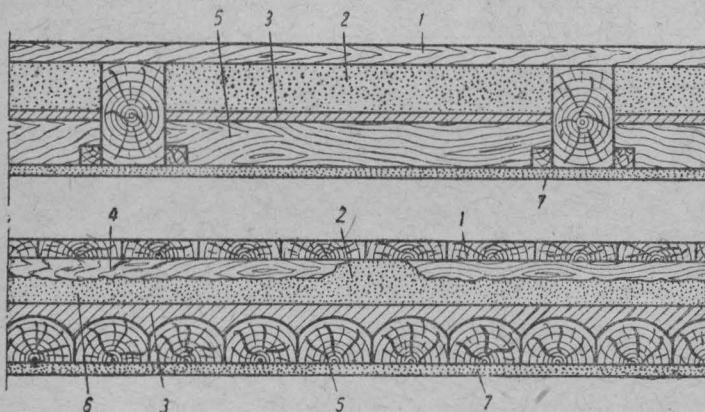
Схема устройства шлаковой отсыпки в деревянном перекрытии:
